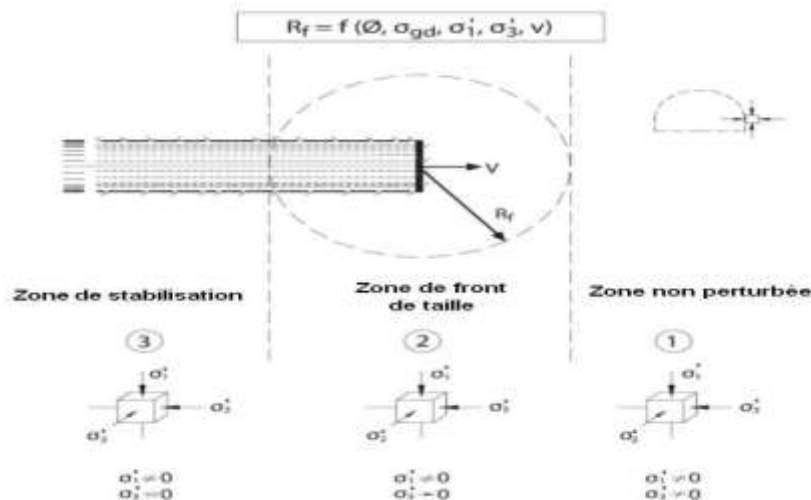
Zones caractérisées lors du creusement d'un tunnel [(Lunardi, 2008)].
